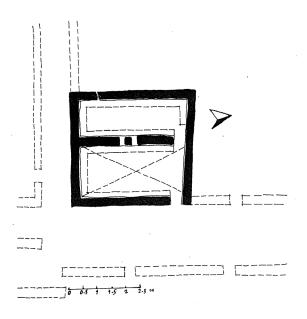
ضريح الشيخ ابو حمام - مسقط أفقى
